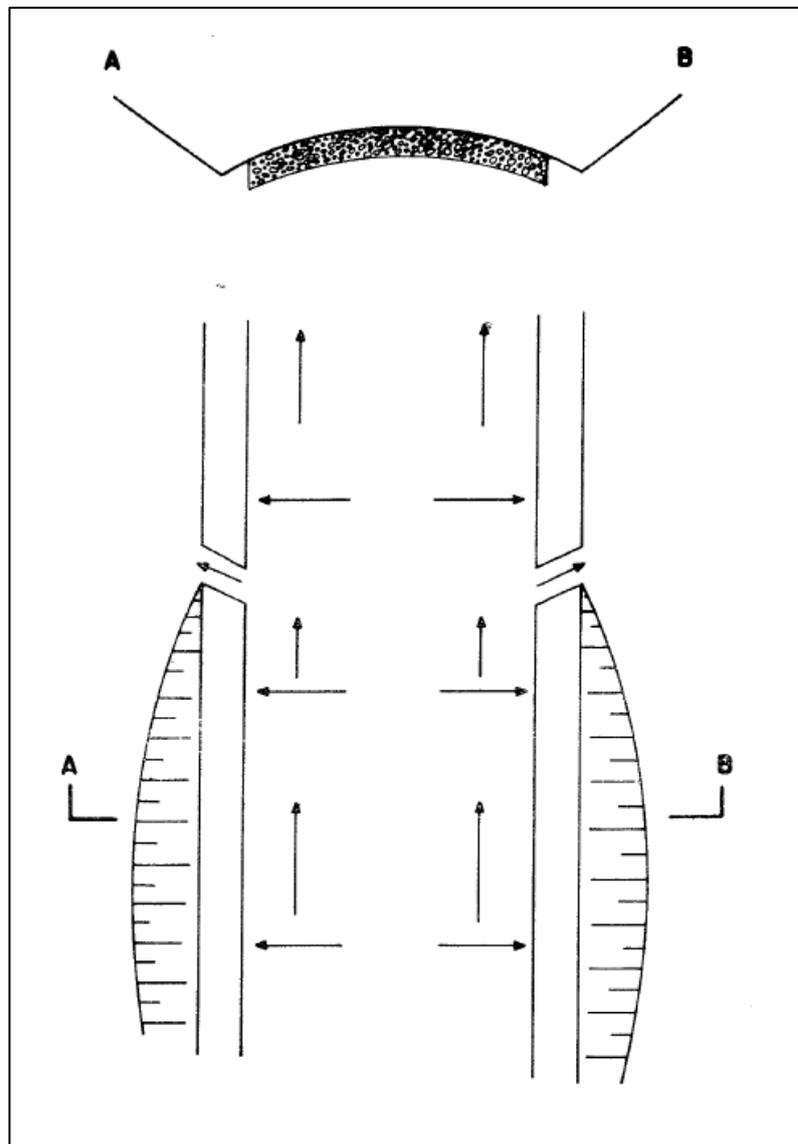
Detalhe esquemático em planta dos dispositivos da via e indicação da declividade
